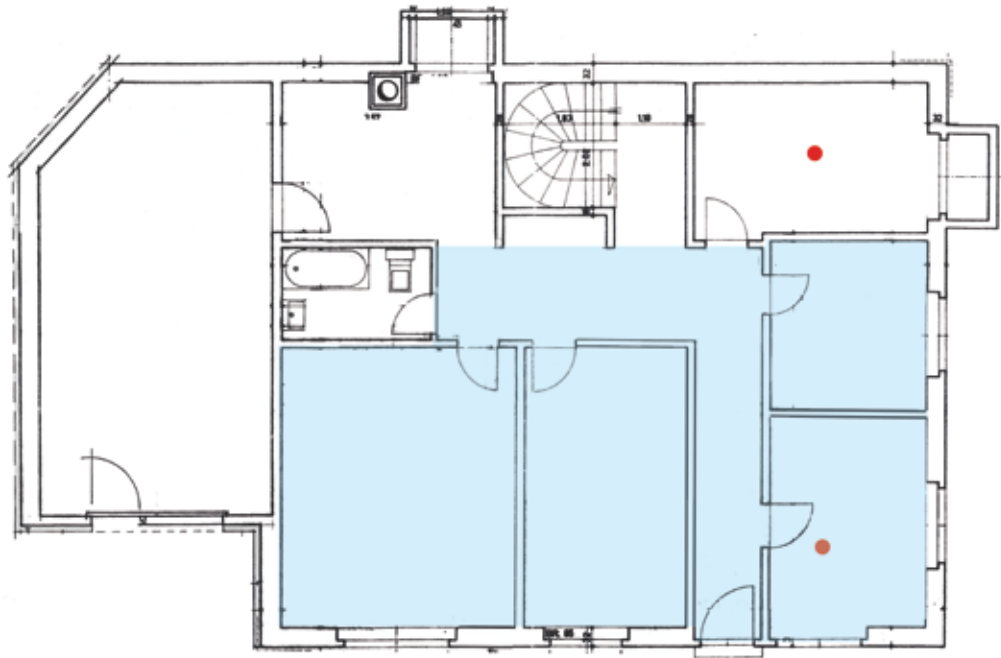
Im Grundriss des Untergeschosses ist die Ferienwohnung blau und die Platzierung der Radondosimeter rot markiert.
